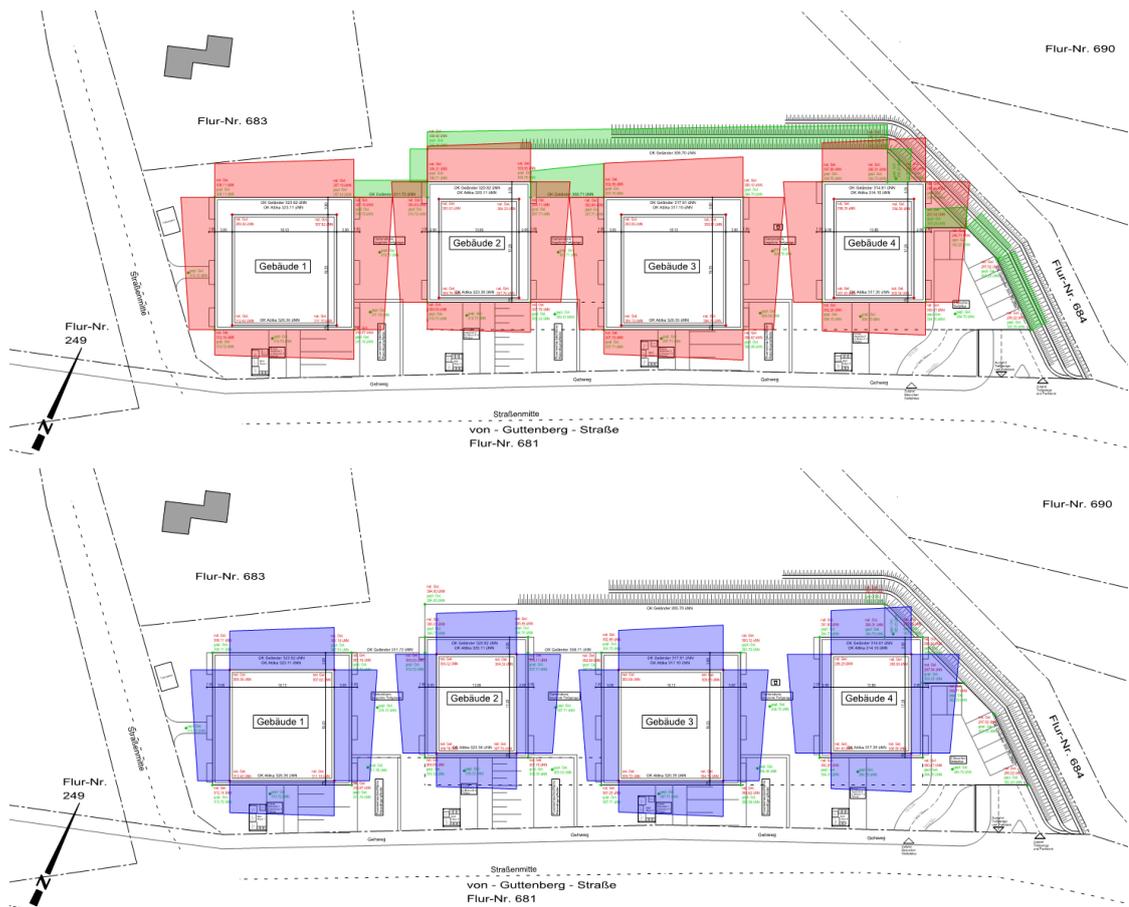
Prüfung der Abstandsflächen nach $0,4 H$ (Architekturbüro eckert+heckelsmüller architekten, Stand 05.03.2021)
